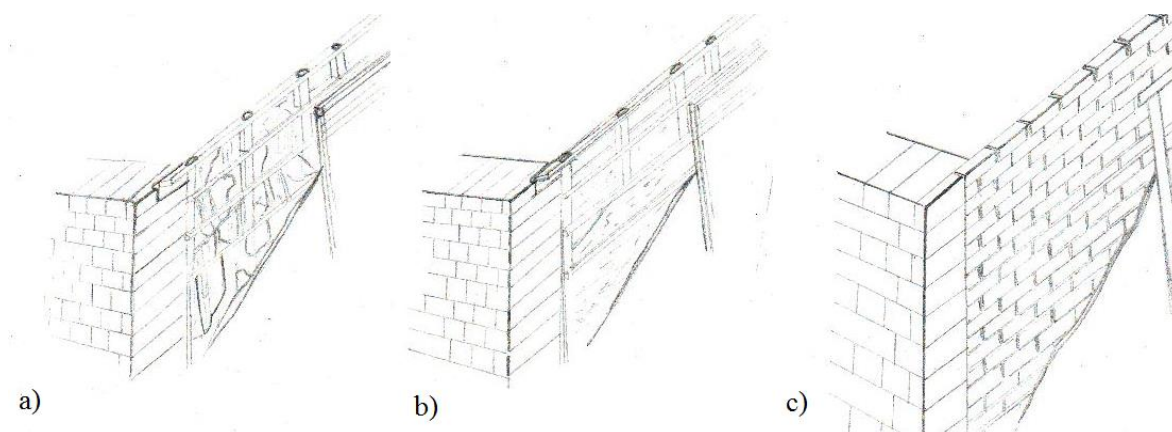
Pormenores construtivos dos três tipos de paredes interiores: a) enxaimel com enchimento de telhas; b) enxaimel com enchimento de terra; c) pano em tijolo maciço (Fonte: de autor)
